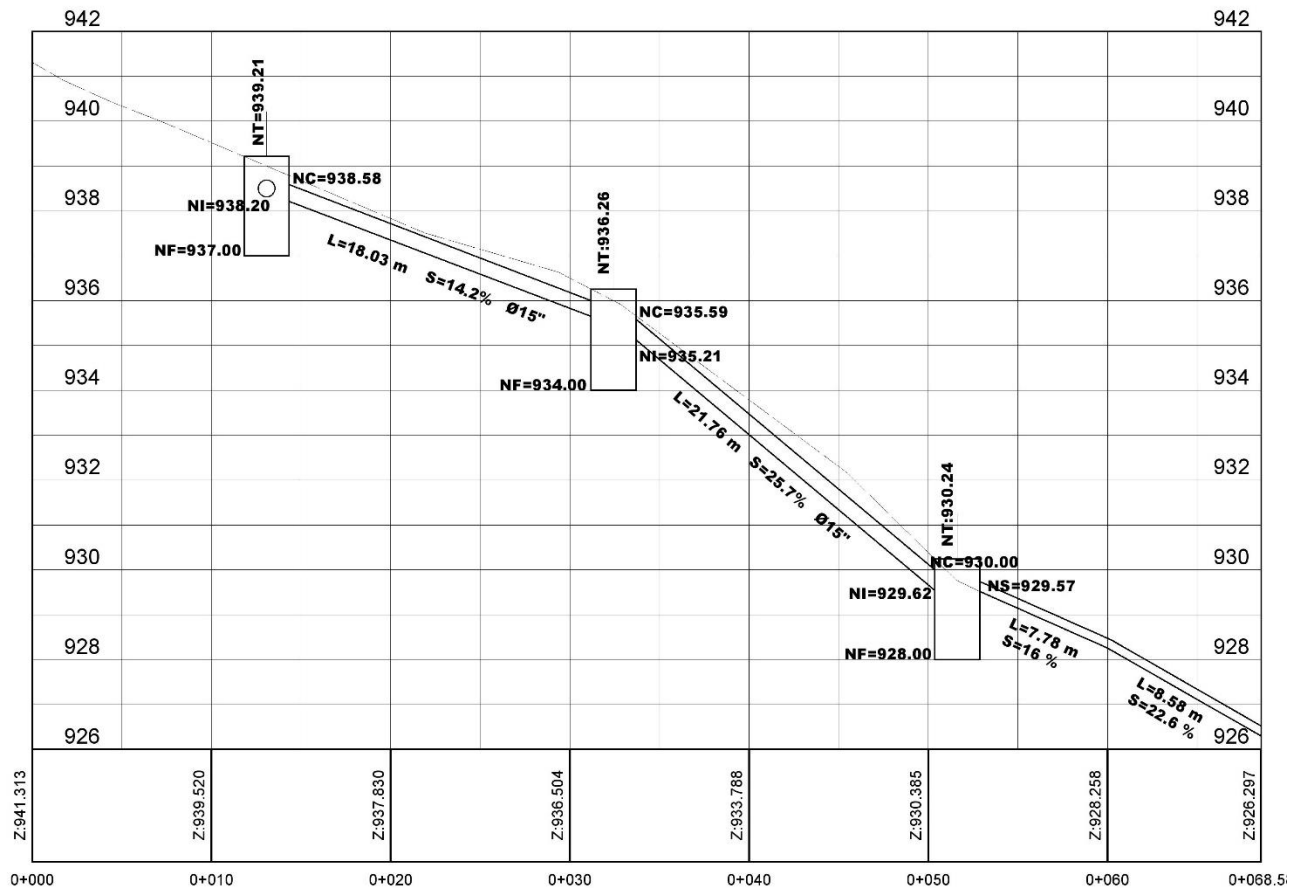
Perfil topográfico de tuberías de drenaje pluvial secundario
